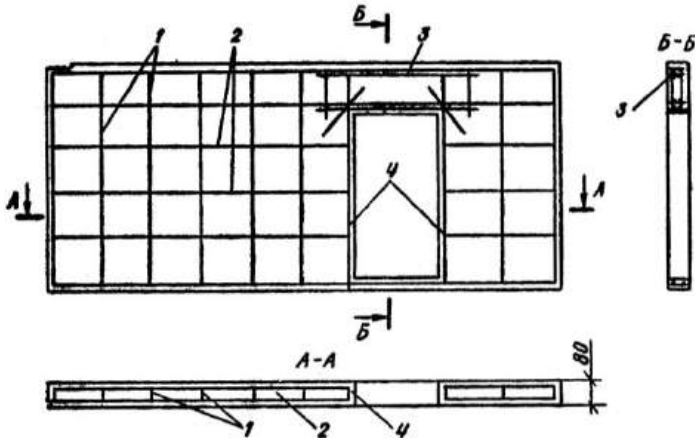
Армування панелі з прорізом для внутрішньої несучої стіни: 1 – вертикальні арматурні каркаси; 2 – те саме, горизонтальні; 3 – арматурний каркас перемички; 4 – арматурні каркаси, розміщені по бічних гранях прорізів
